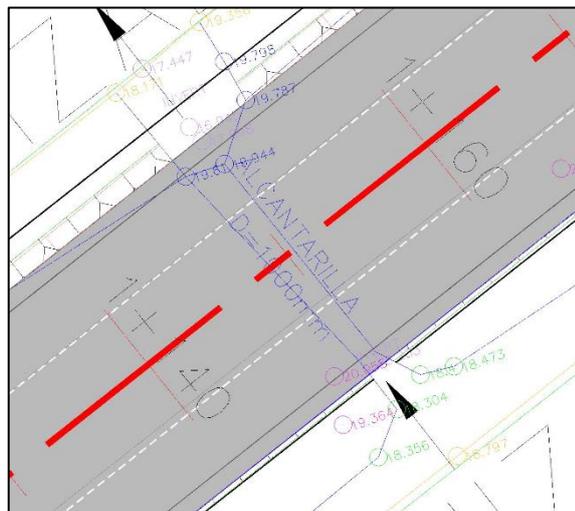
Vista en planta de Alcantarilla en abscisa 1+150.
